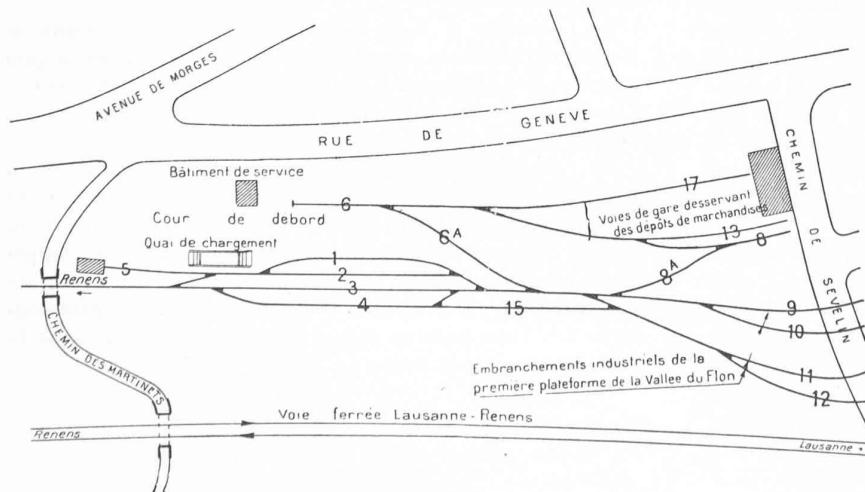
Plan de la gare actuelle de Sébeillon.
